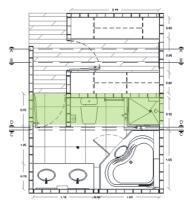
Diseño en alzado D de baño, departamento torre Mitikah. Elaboración conjunta, Álvarez, González, Hurtado. 2022
